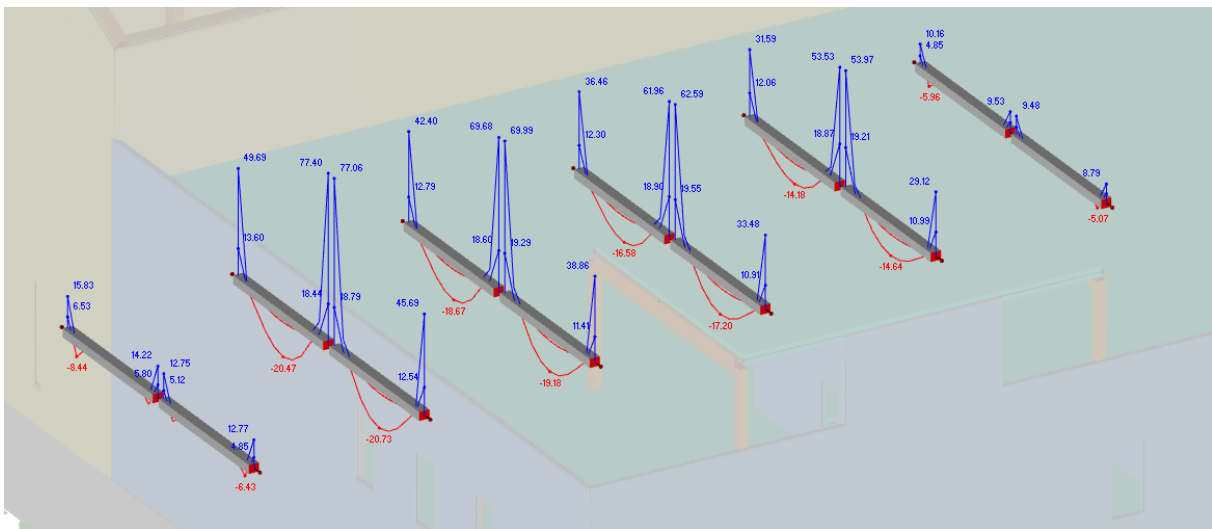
Vigas de atado del sótano. Momentos flectores.
